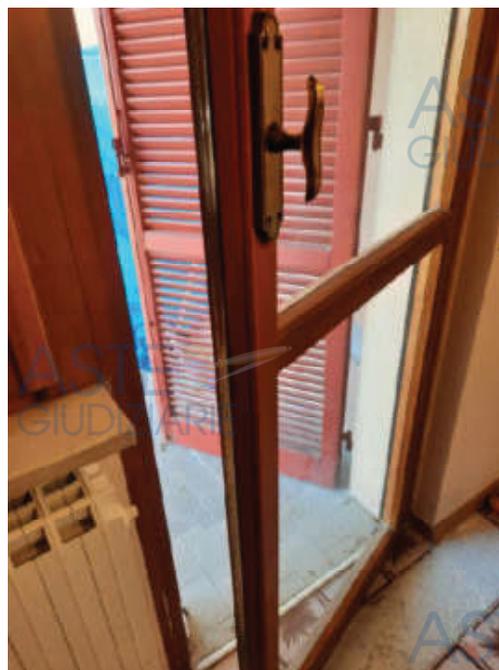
sub 8 disimpegno e porta di accesso alle scale interne per raggiungere il piano secondo
